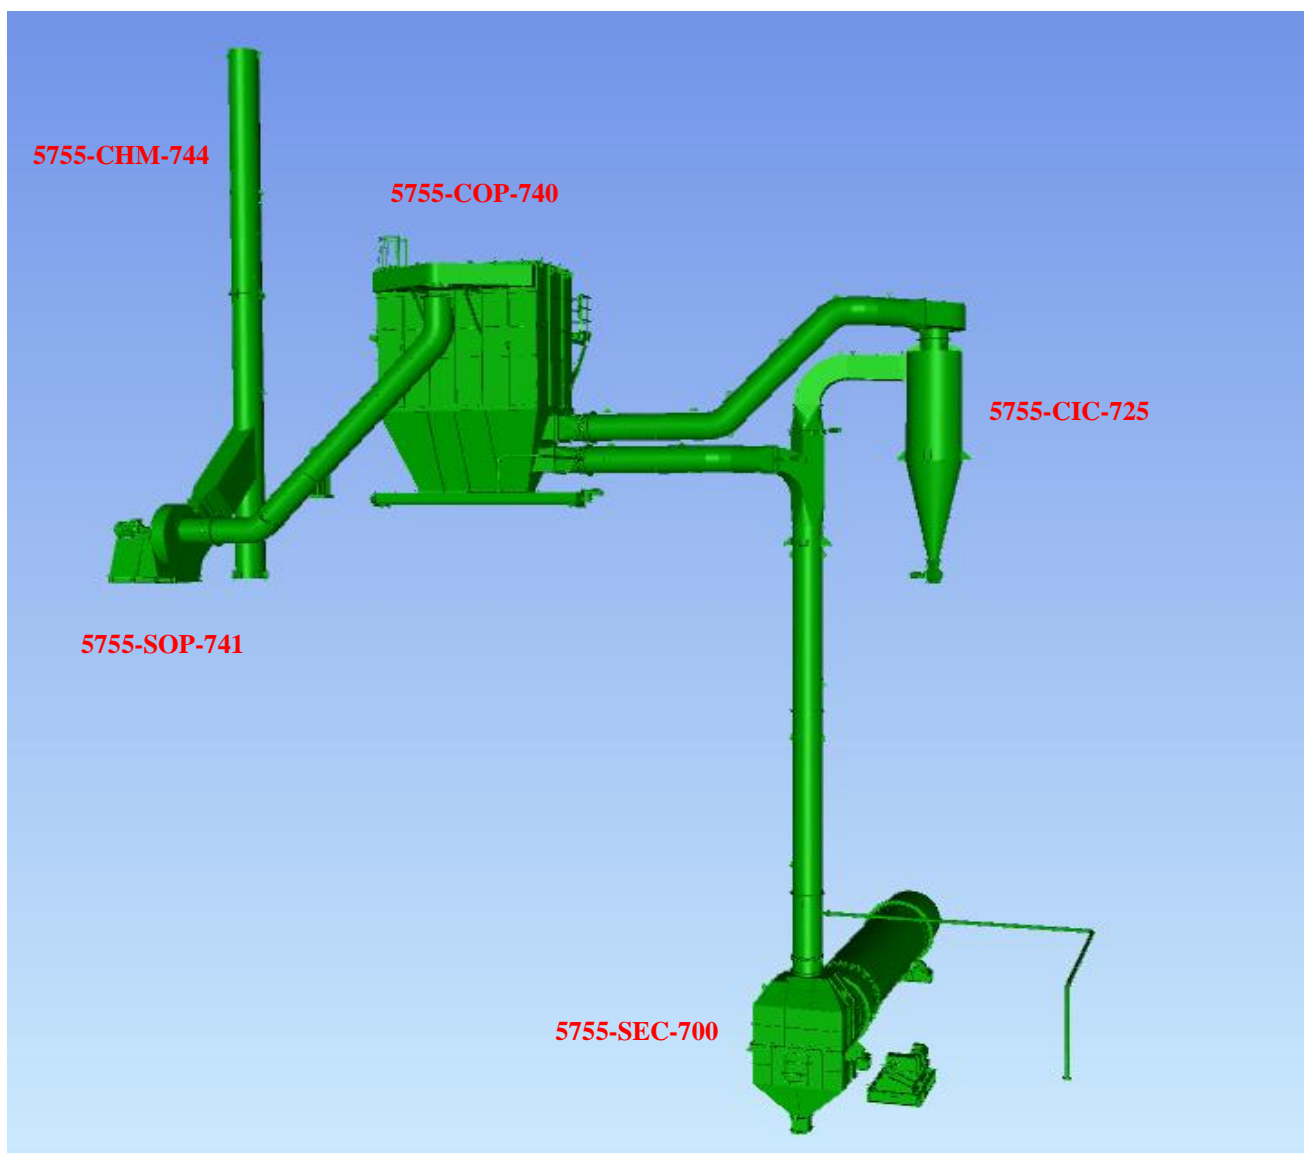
, Vista 3D de Edificio de Centrifugado y Secado
